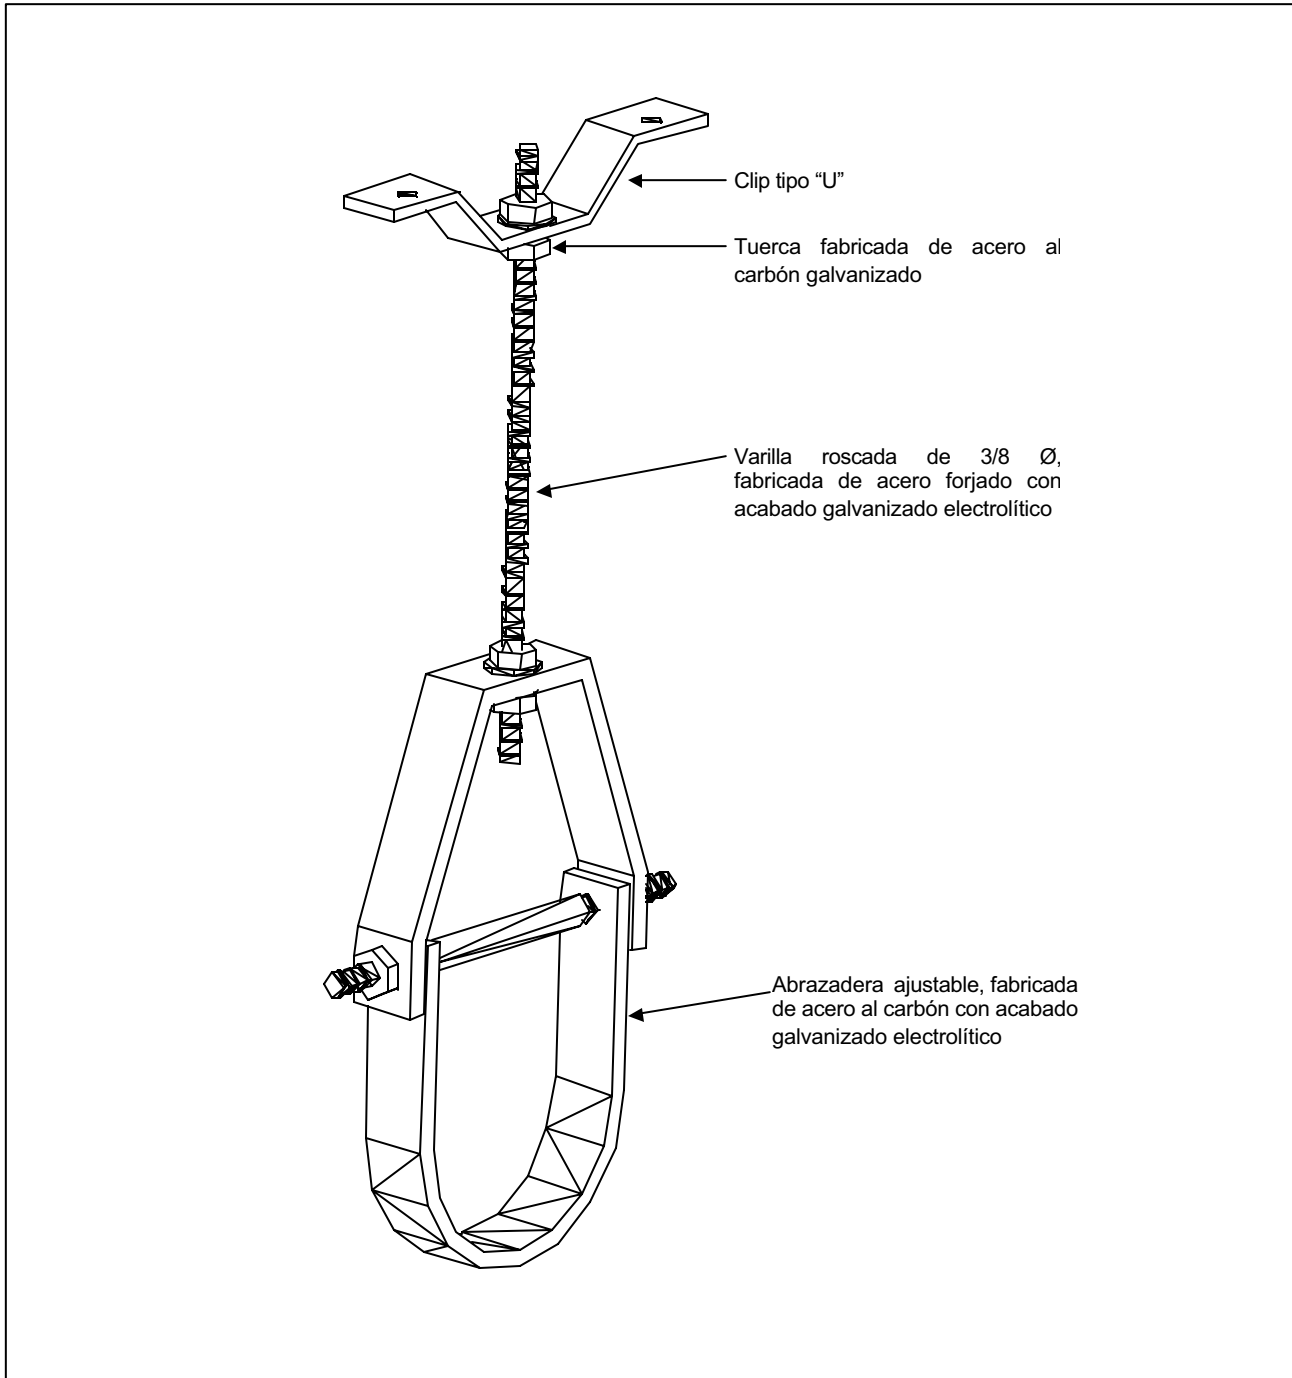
Soporte para tubería en interior de un edificio.
